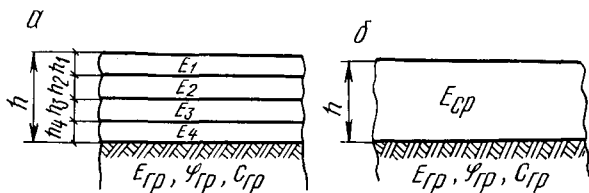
Схема приведения многослойной конструкции а к двухслойной б
